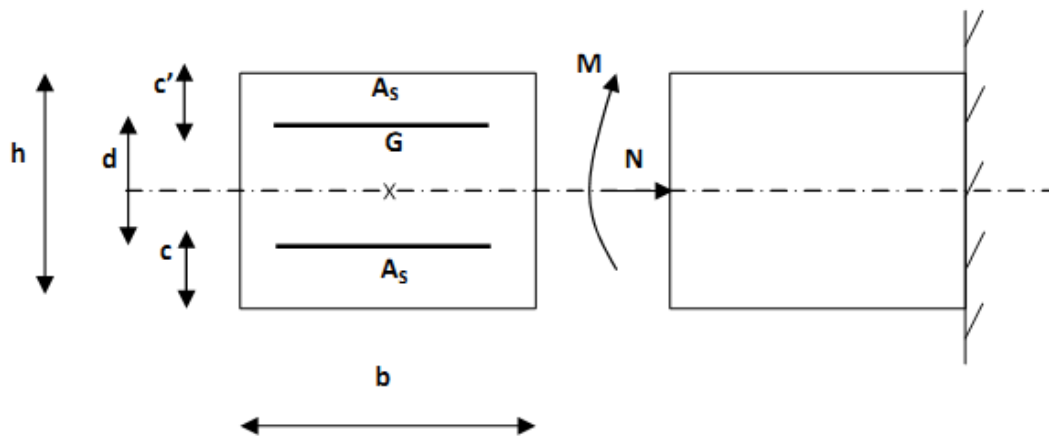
Section rectangulaire soumise à la flexion
